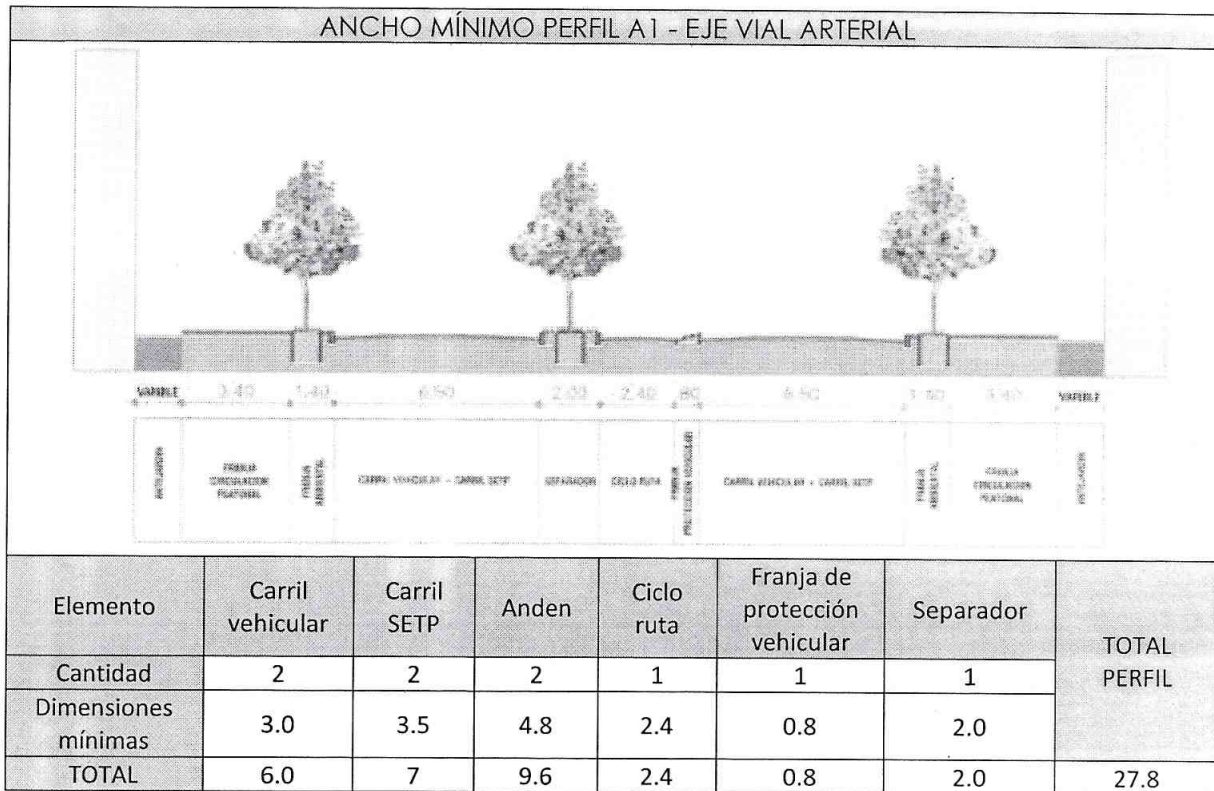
Ancho mínimo perfil a1 - eje vial arterial
